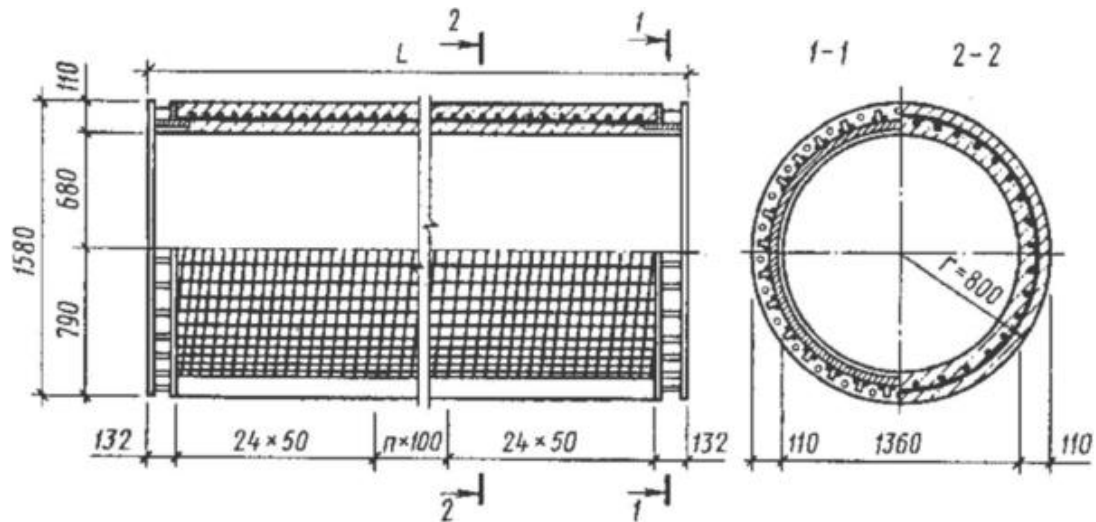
Конструктивна схема залізобетонної оболонки.
